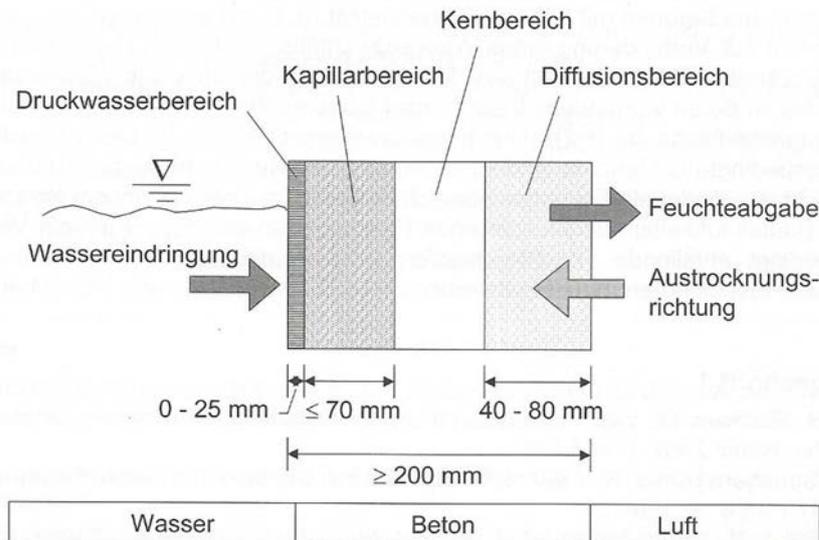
Arbeitsmodell (in Anlehnung an [1.2, 1.3]) für Feuchtebedingungen in einem Betonbauteil-Querschnitt unter einseitiger Beaufschlagung mit drückendem Wasser (Beton B35 WU, $w/z \leq 0,55$)
